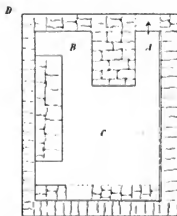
(Grundriss der Grundmauern der Villa)
